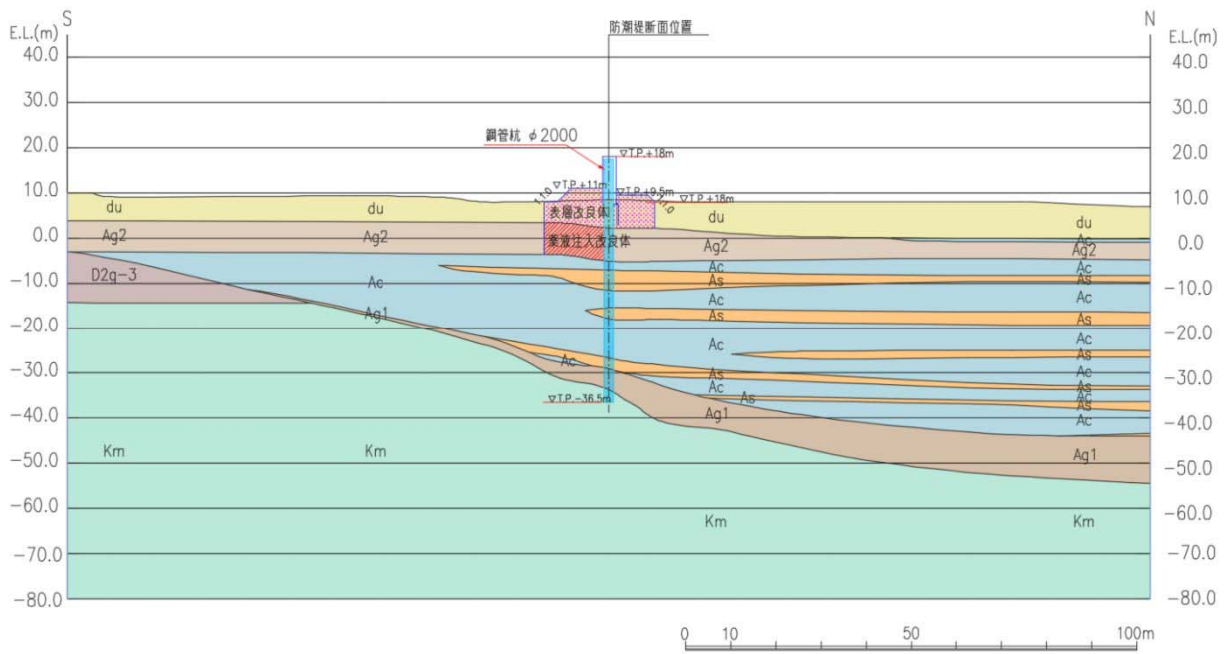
(5) 鋼管杭鉄筋コンクリート防潮壁 断面図 (断面⑤)
